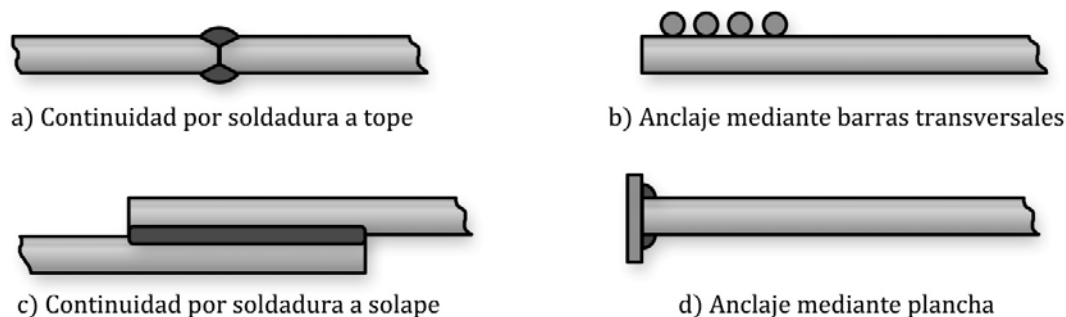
Empleo de soldadura en barras de acero
